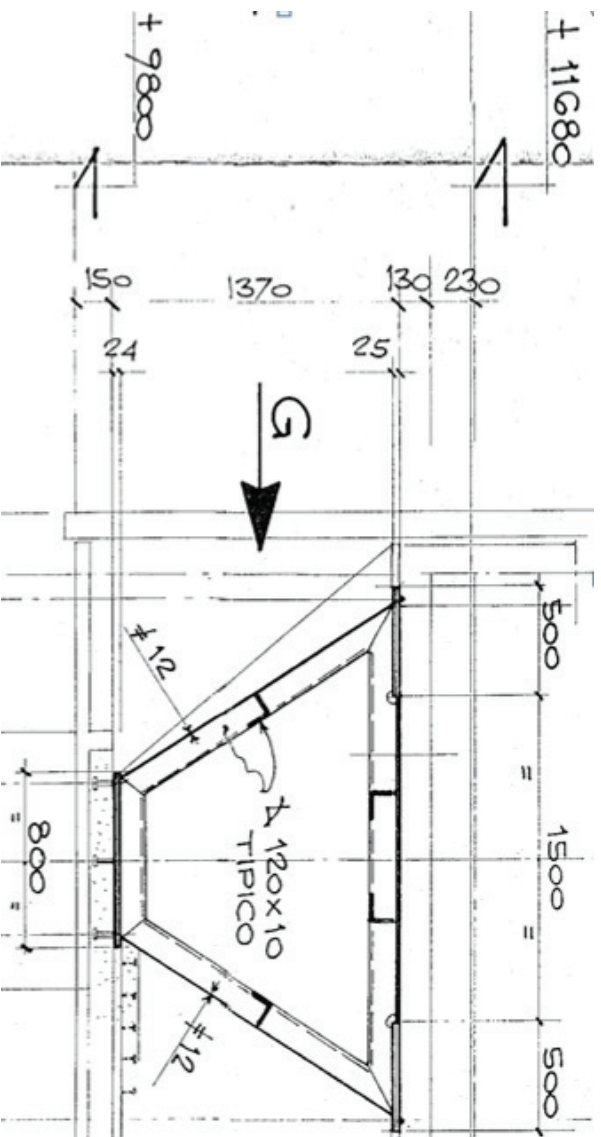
Particolare costruttivo trave metallica a cassone
